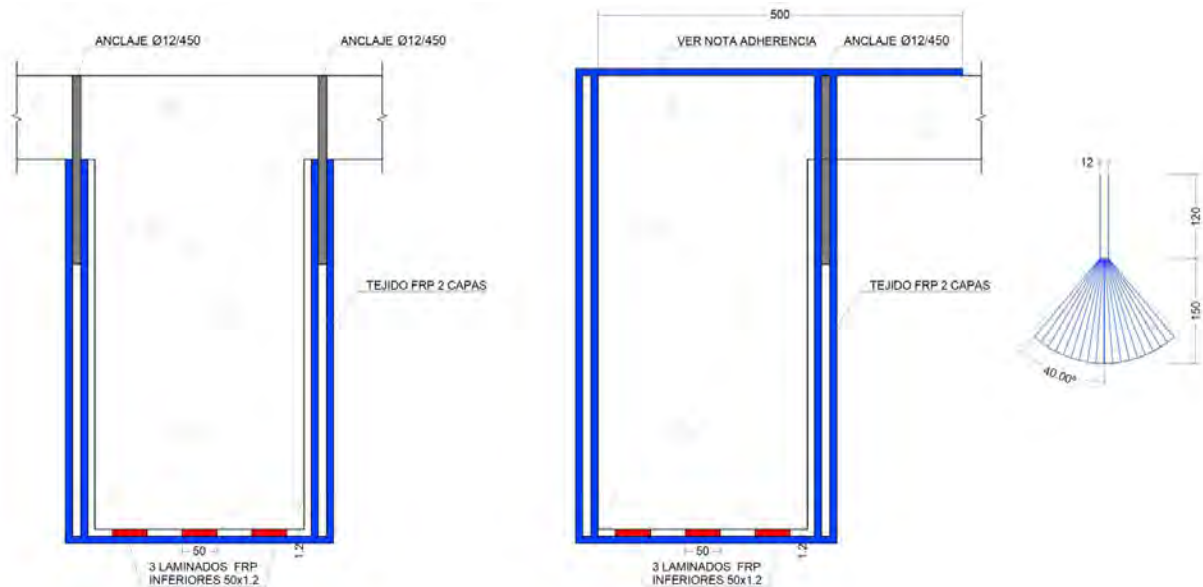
Detalle de anclaje de los tejidos de FRP de refuerzo a cortante en vigas interiores y de borde.
